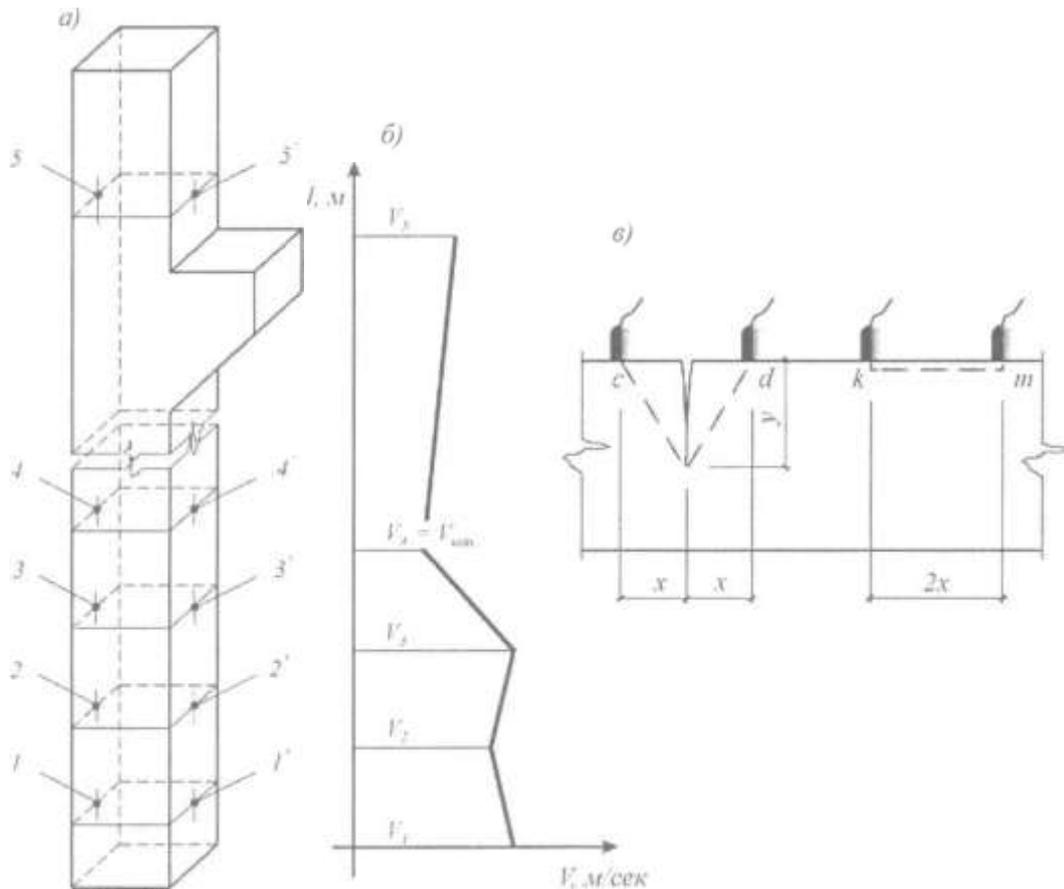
Обследование железобетонных конструкций с помощью ультразвука:
